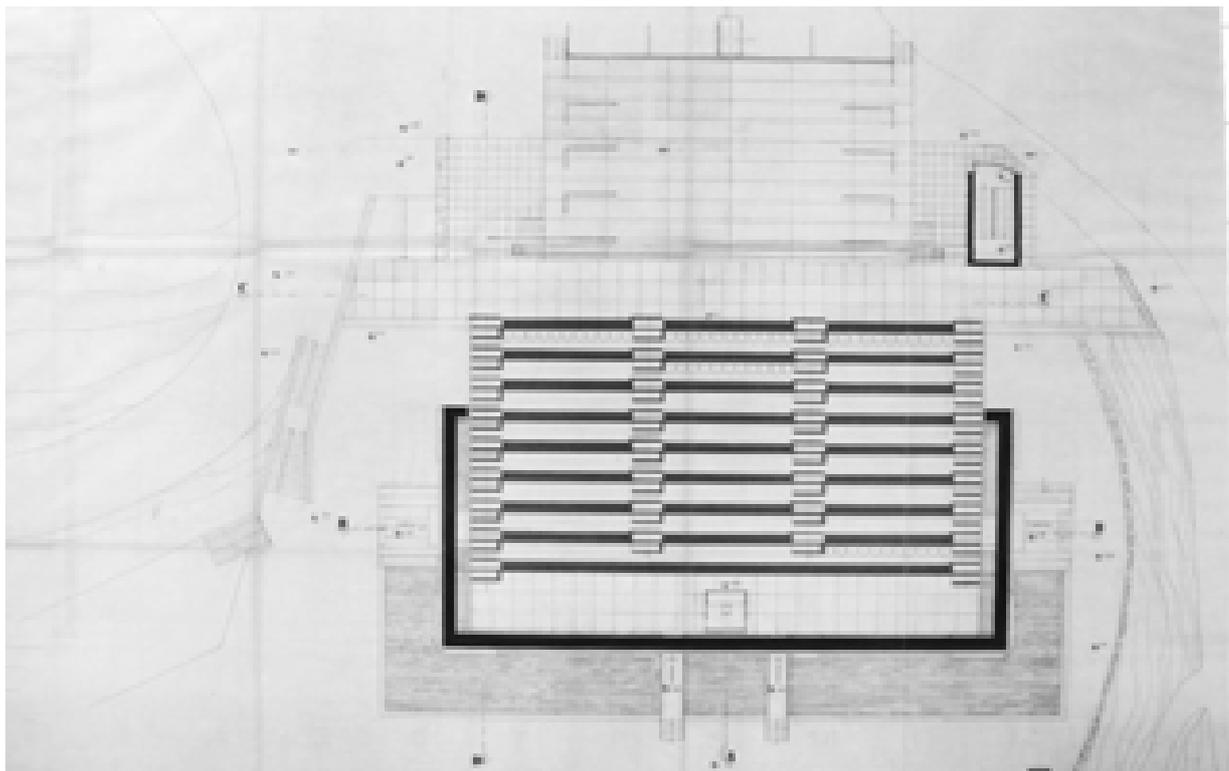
Pianta coperture, opere di completamento – 22/04/1997 (AABS-533)
